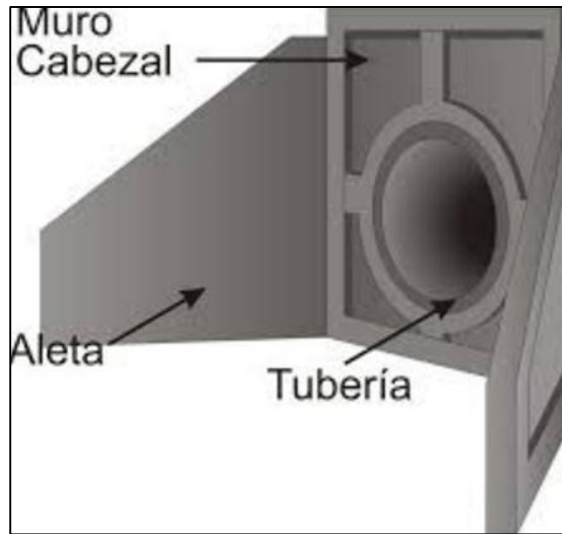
Estructura de entrada o salida de la alcantarilla.
